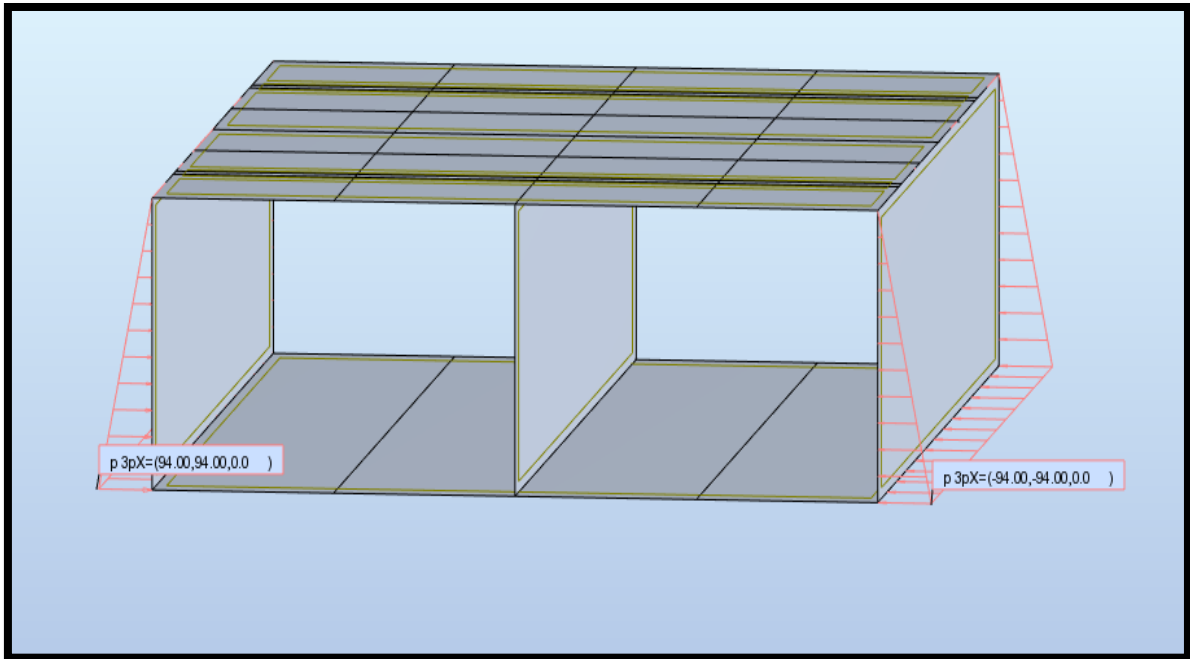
Poussée des terres (G_{remb}) sur la culée du pont cadre
